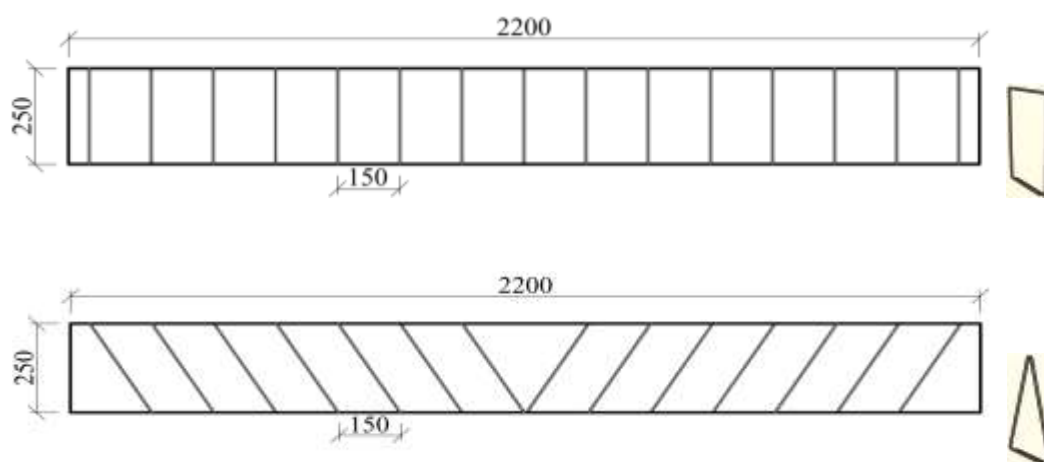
Geometria das vigas e estribos (SANTOS *et al.* 2011).
